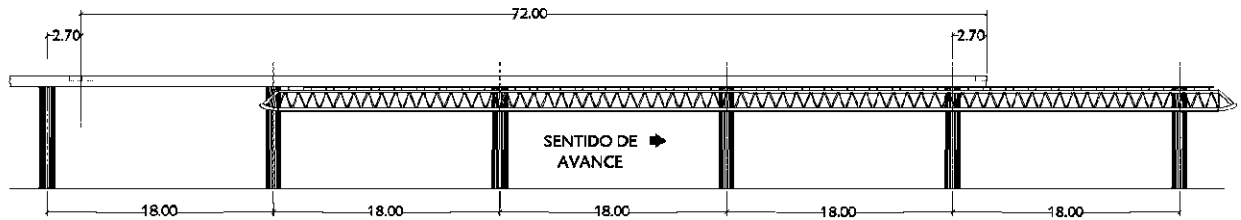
Proceso constructivo, descimbrado y movimiento del encofrado autoportante para su posterior utilización en el pórtico siguiente.
